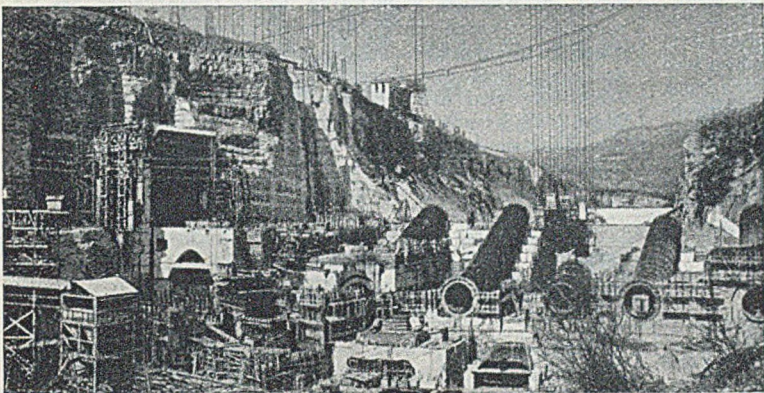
Gesamtansicht der Baustelle mit den bewehrten Leitungen.
